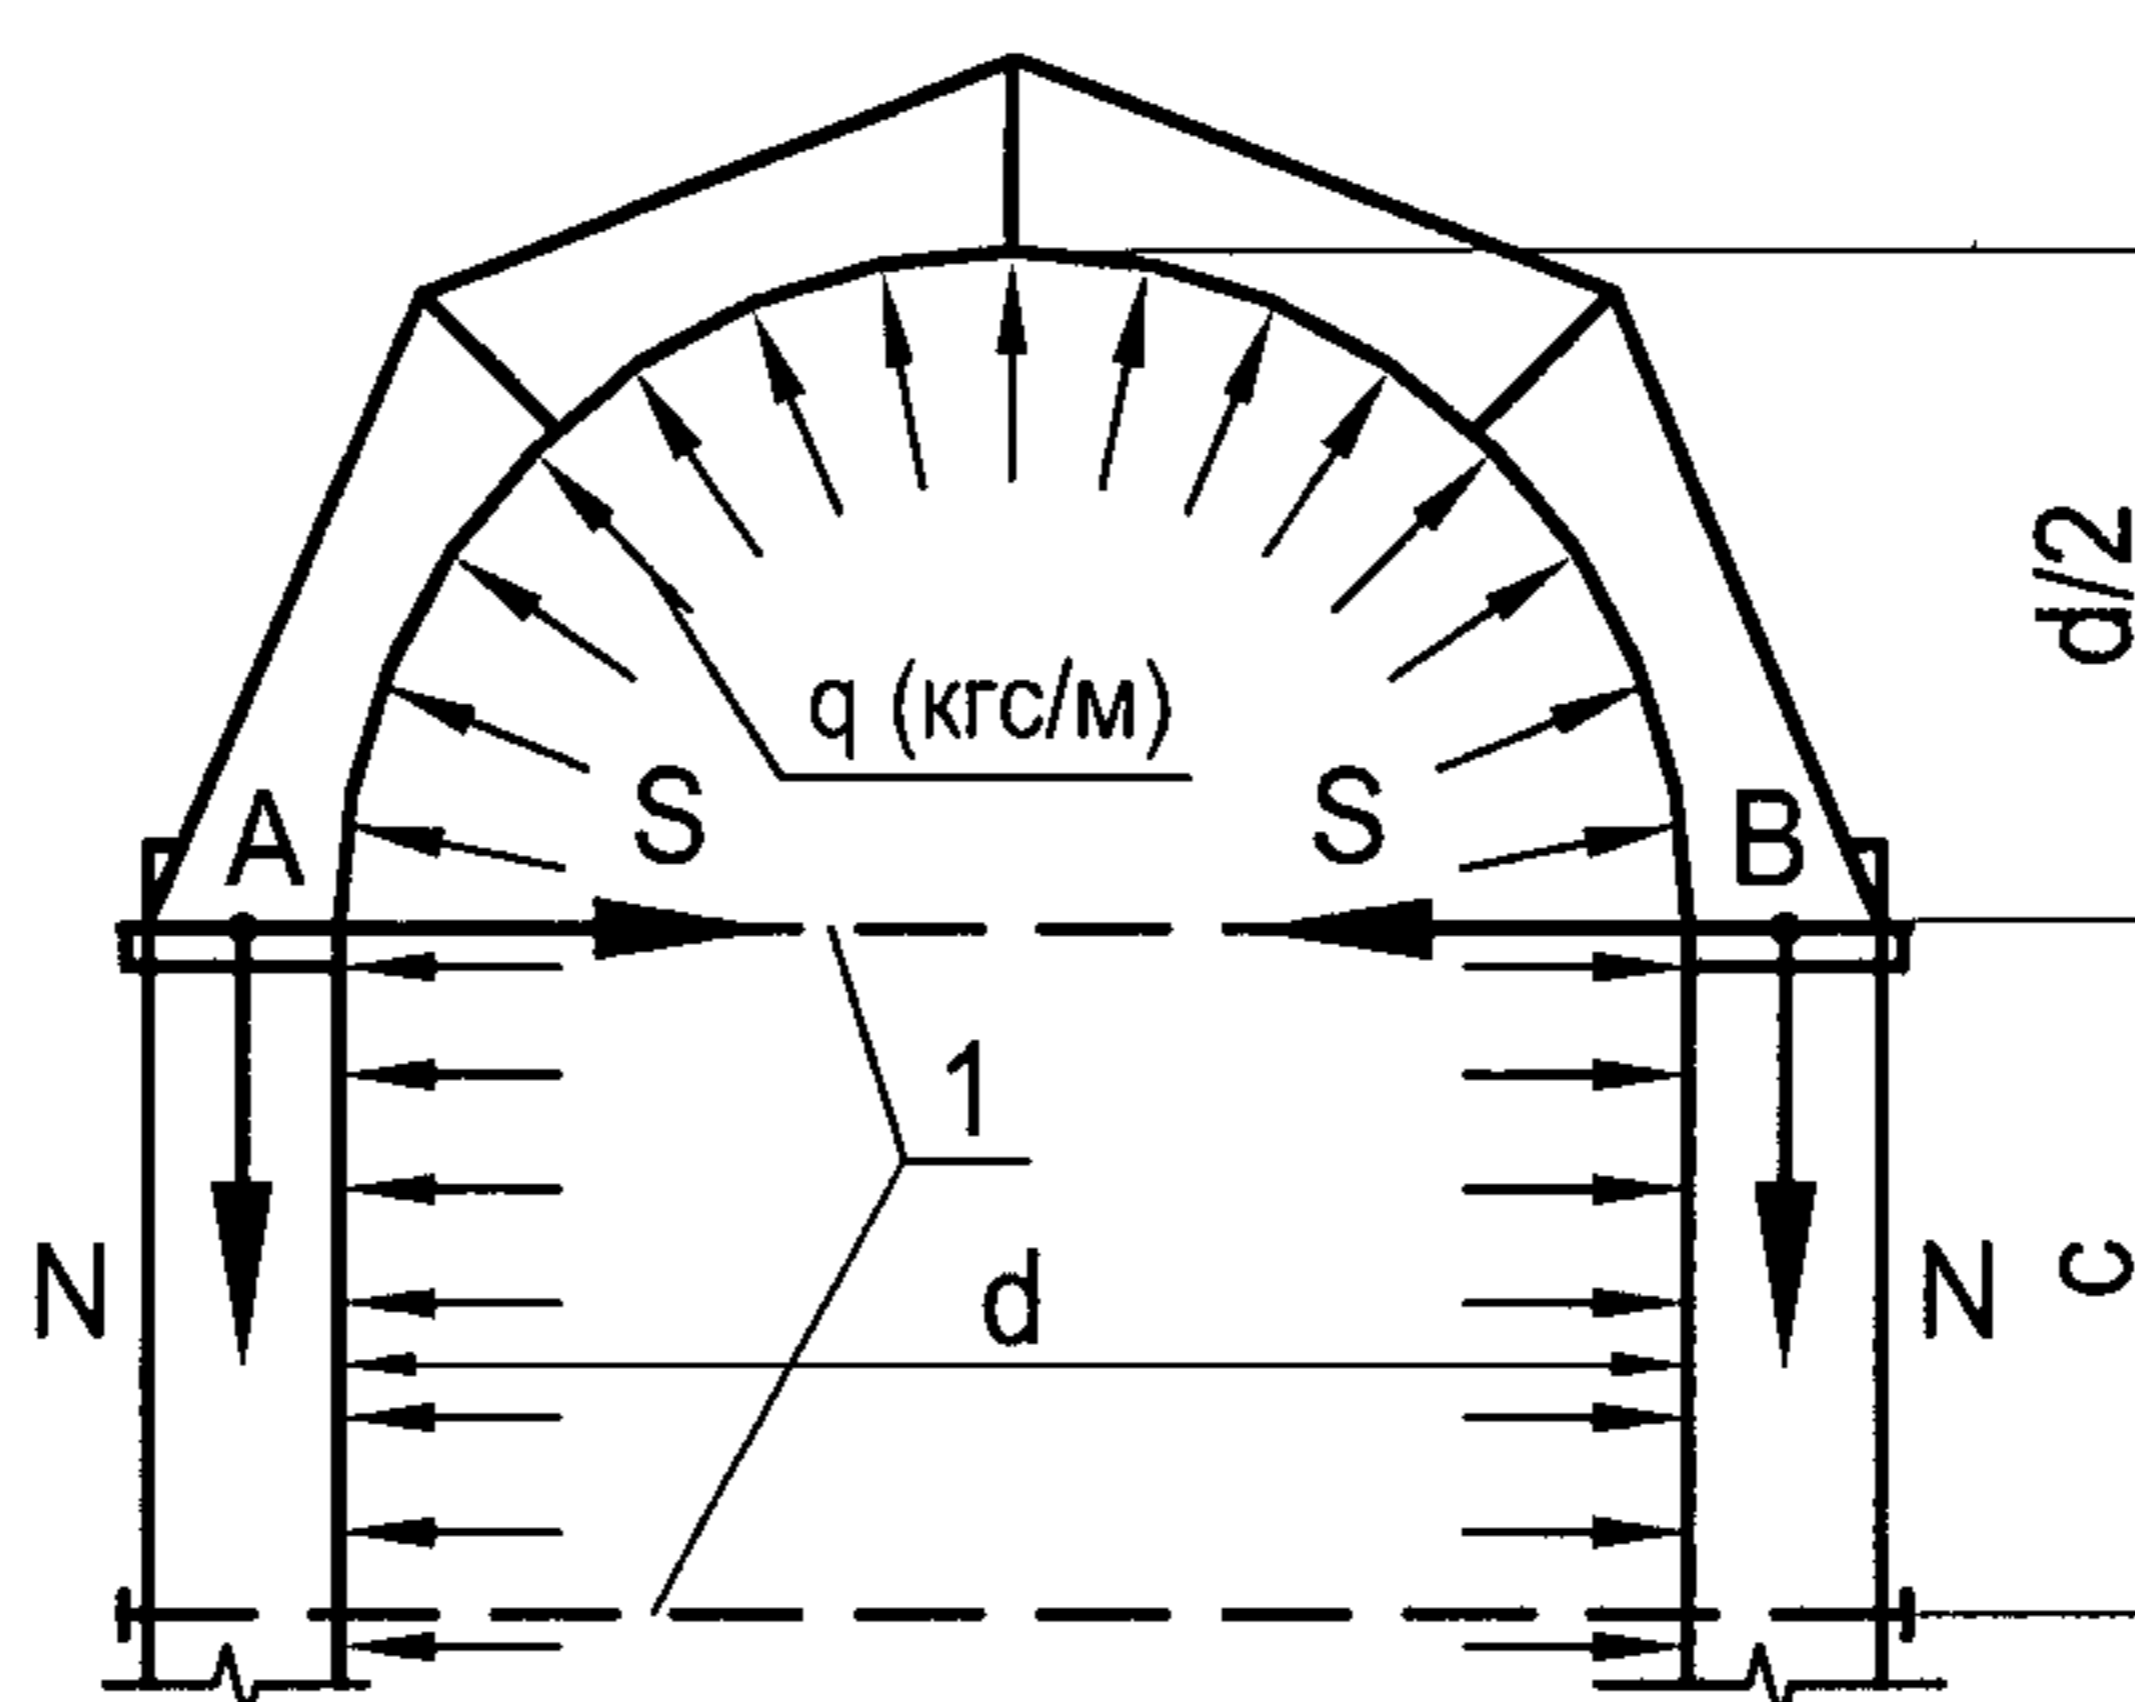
Расчетная схема кружальных ребер опалубки опор
